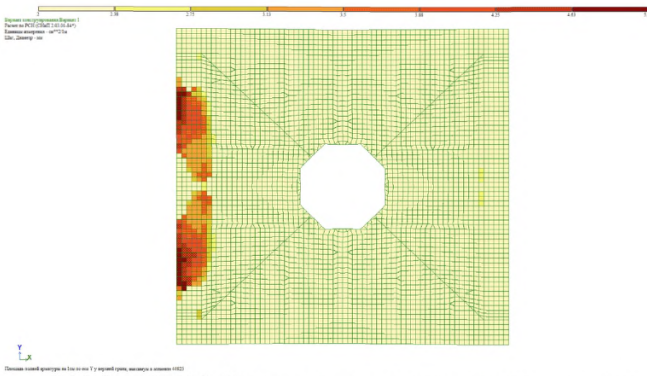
ЛР №3. Верхнее армирование складчатого покрытия по оси  $Y$
